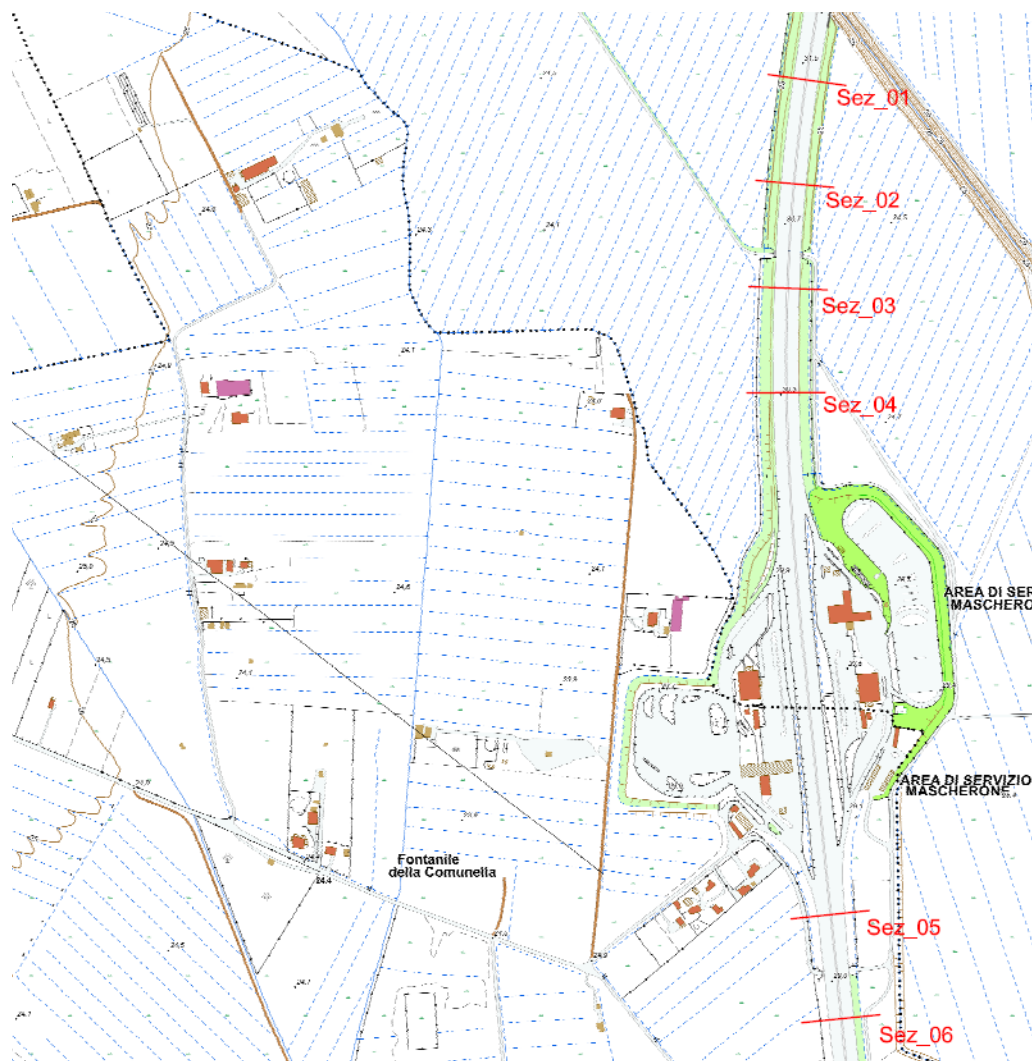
Sezioni del rilevato autostradale nell'area di progetto (1 – 6)
